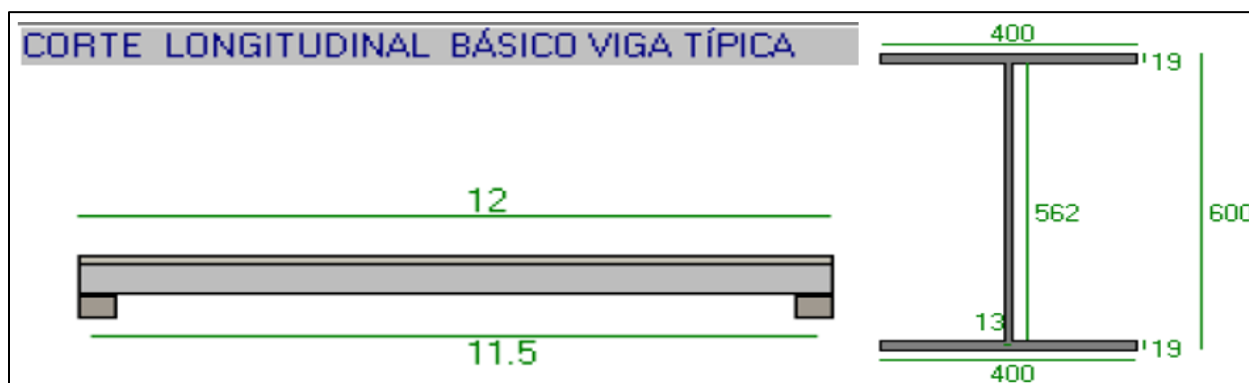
Esquema de la superestructura del puente en perfiles metálicos.
